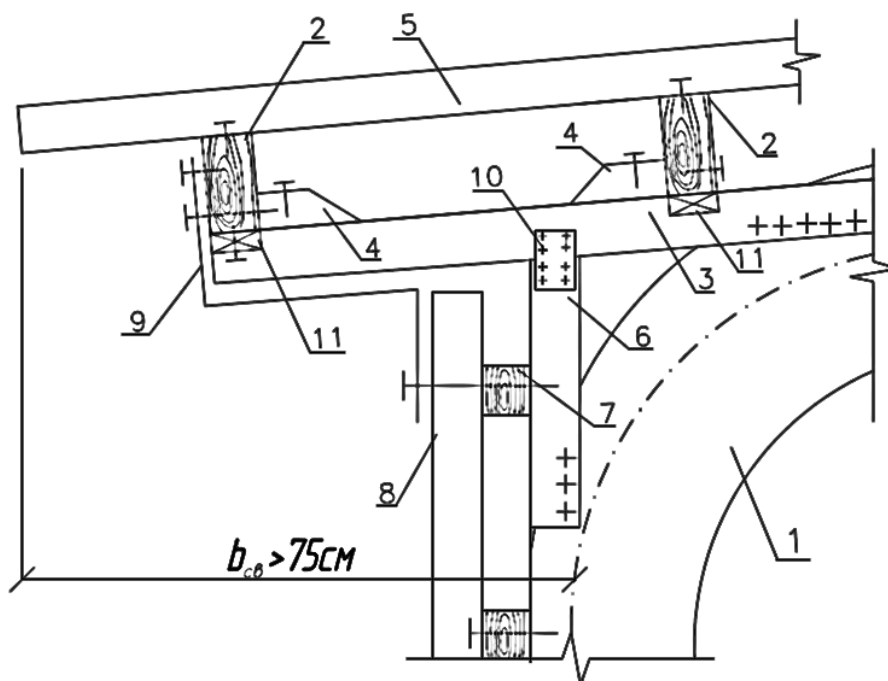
Конструктивное решение примыкания кровли и стен к гнукотклееной раме:
